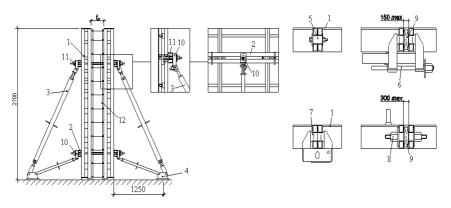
Схема каркасной опалубки для стен системы «МОДОСТР»
